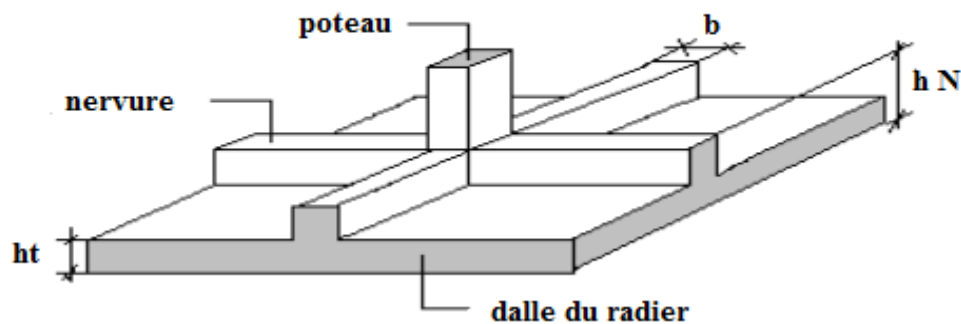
Disposition des nervures par rapport au radier et aux poteaux
